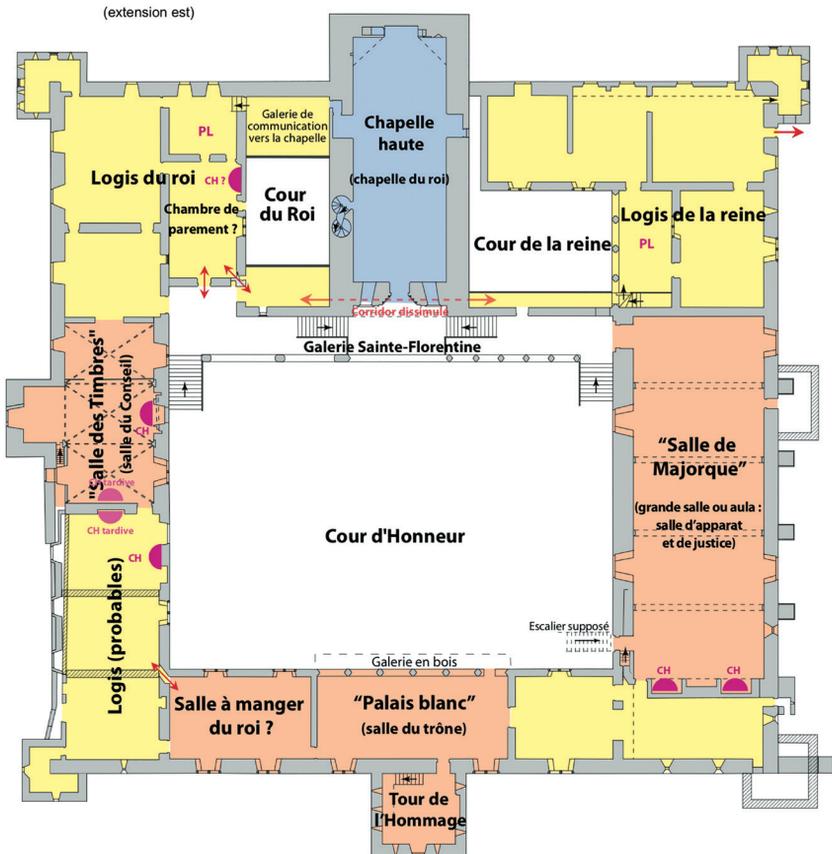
Plan du château royal de Perpignan (© A. Marin et B. Pousthomis)
